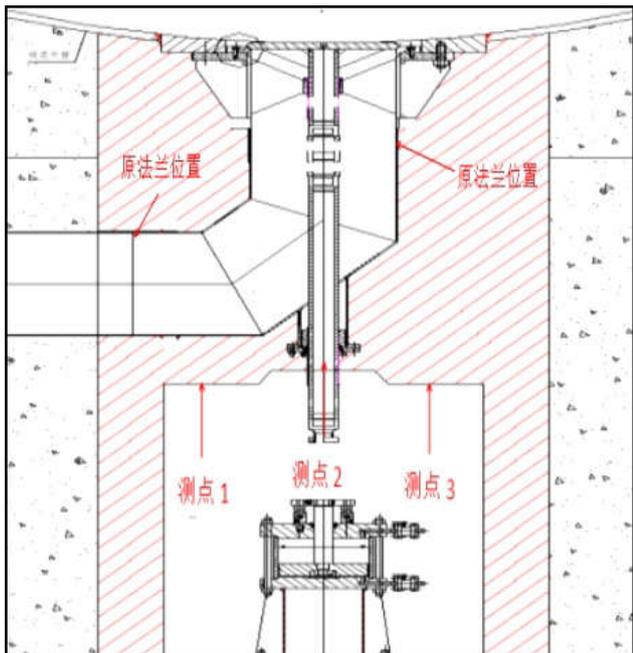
蜗壳盘形阀外包混凝土浇筑方案示意图
